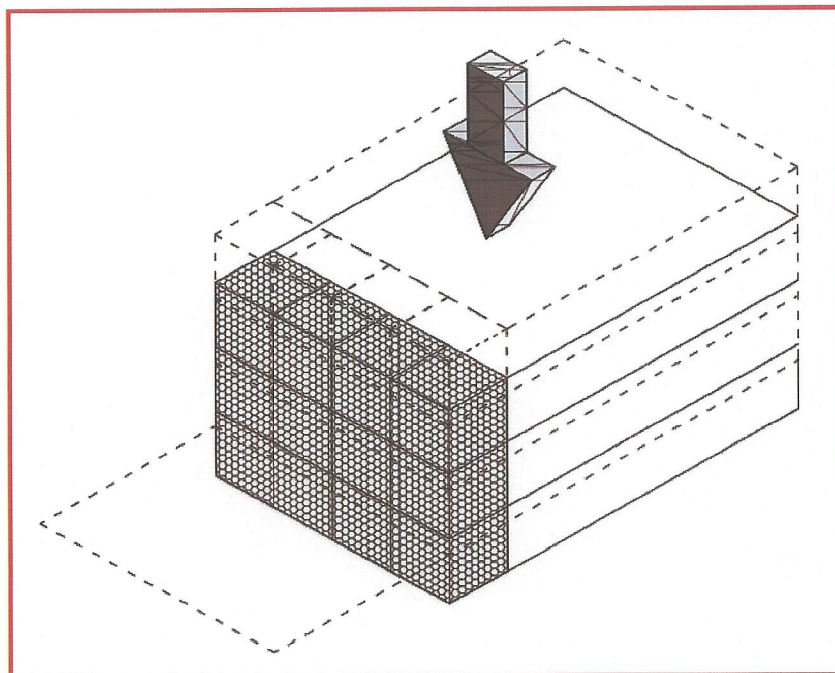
Presión del bloque reforzado aplicado sobre la fundación.
